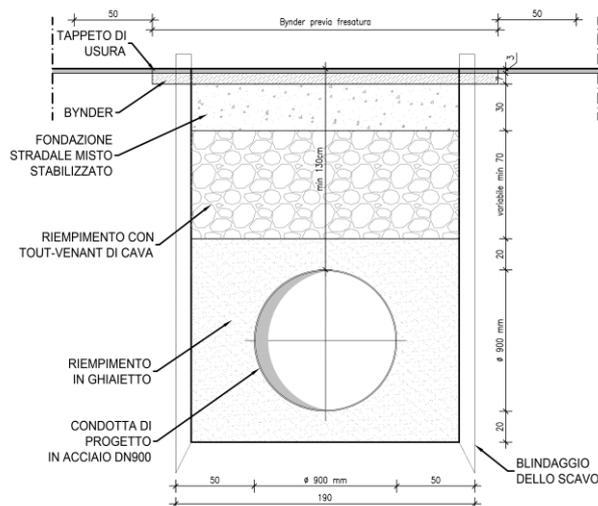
Sezione tipo di posa su strada comunale asfaltata.
